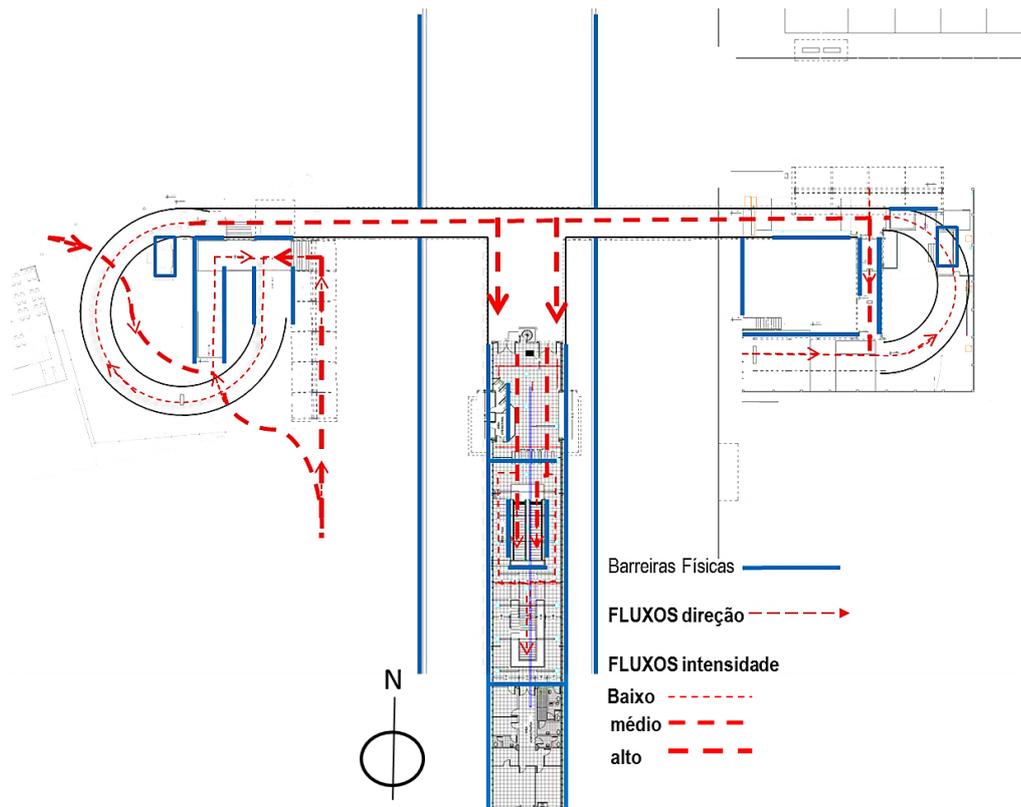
Planta baixa Praça Niterói, lado leste Poa-Nh
